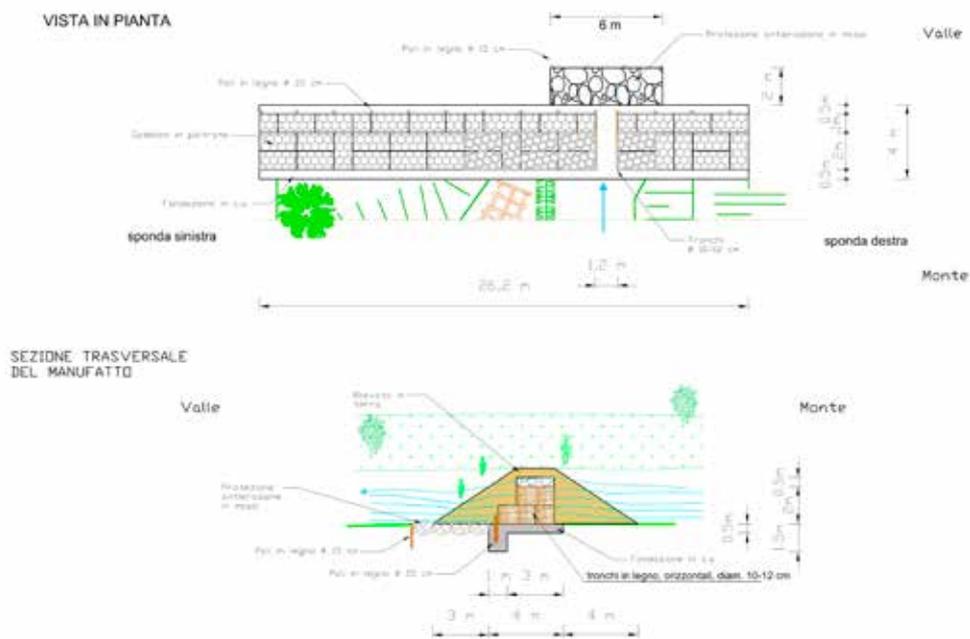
Vista in pianta e sezione trasversale (esempio tratto dal progetto realizzato sul Rio Bianello)
